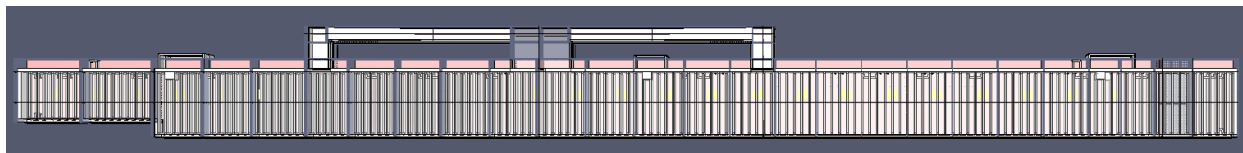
Geometria de la planta PS-4 dissenyada amb Pyrosim.
